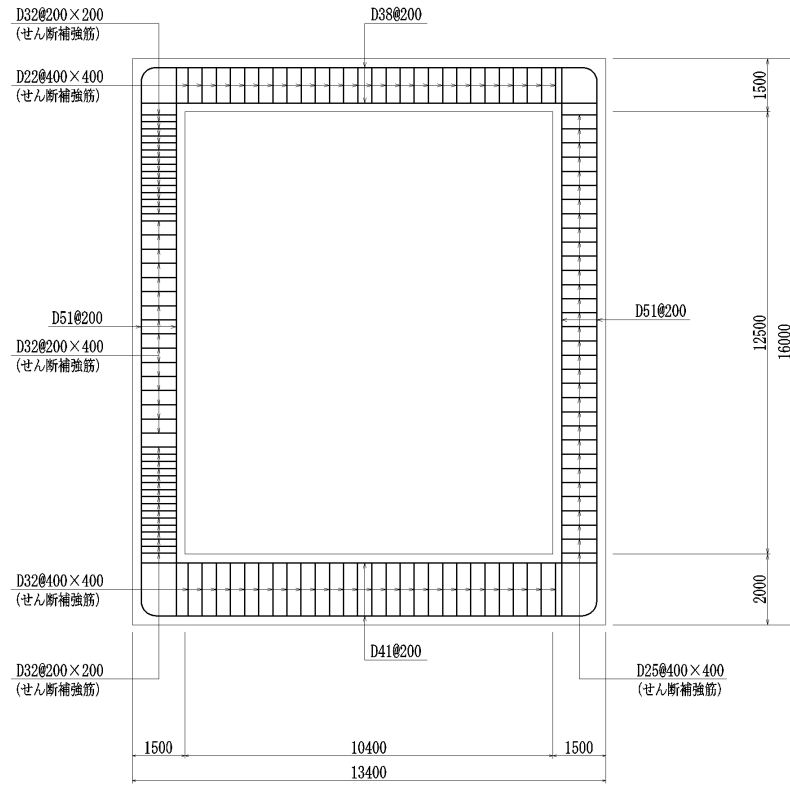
低圧原子炉代替注水ポンプ格納槽 概略配筋図 (A-A 断面)
